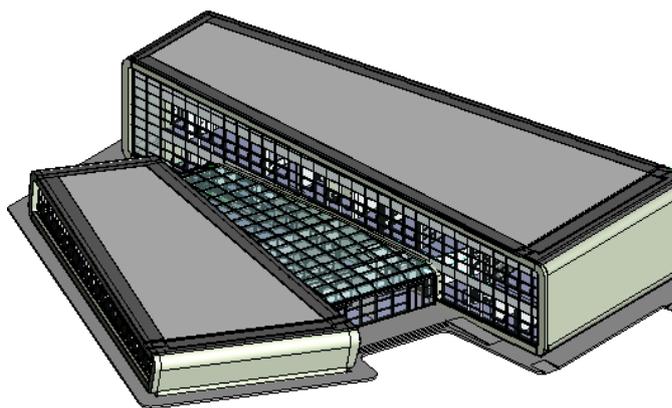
PCC - Vista prospettica dei fabbricati Nord Ovest
